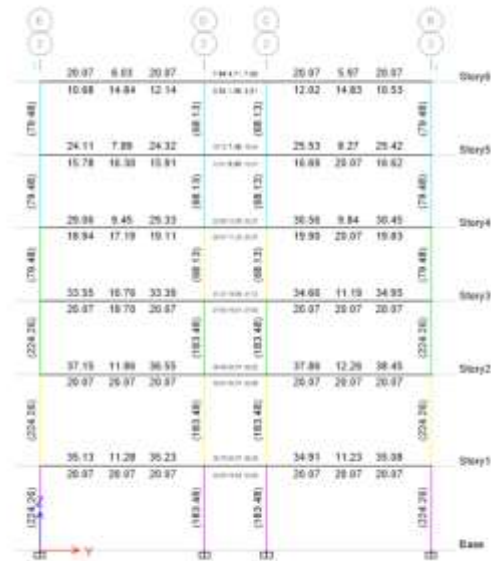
REFUERZO LONGITUDINAL EJE 2
